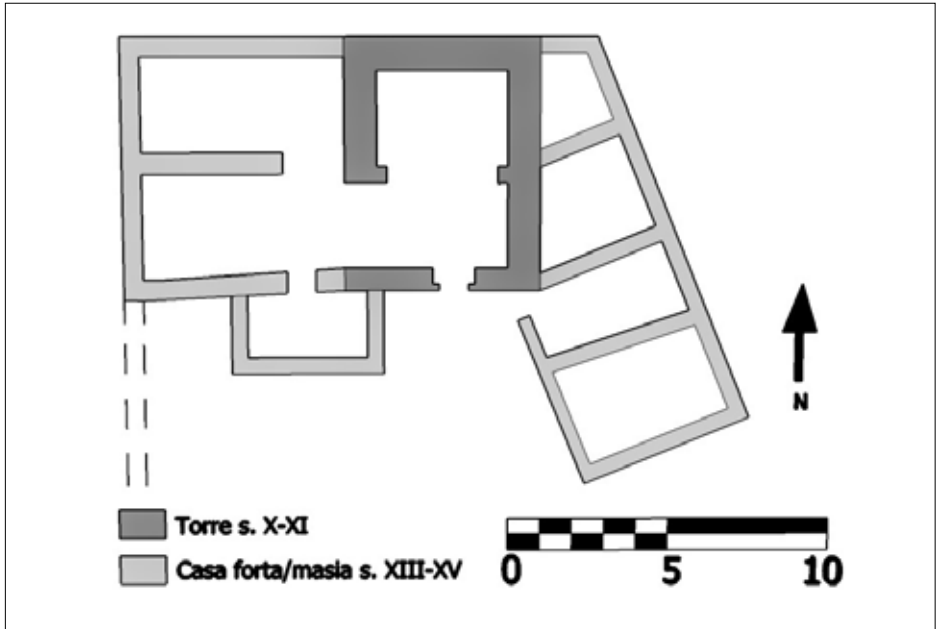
Planta de la casa forta/masia dels segles XIII-XV.
